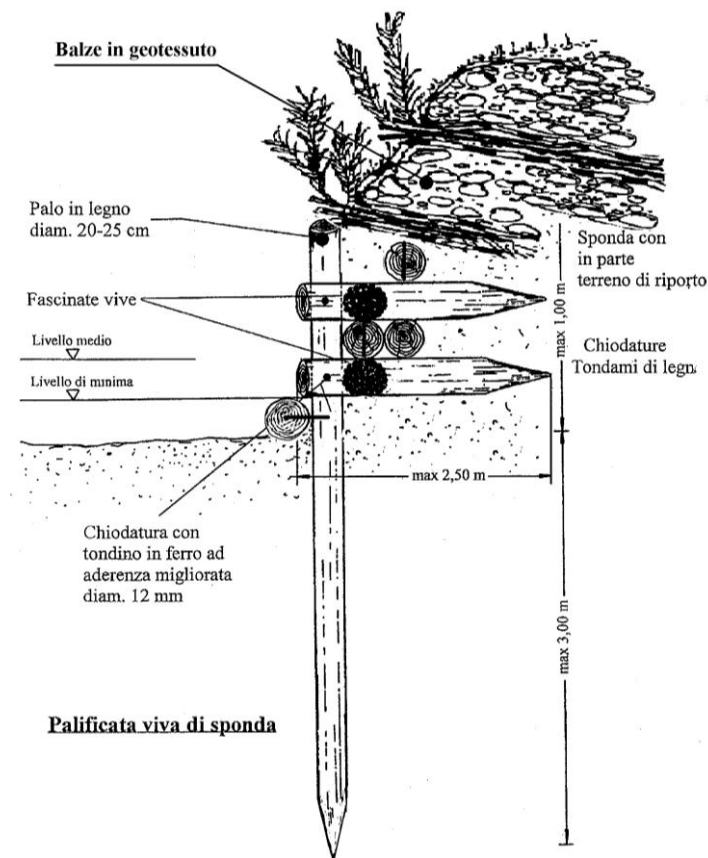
Sezione tipo di palificata viva di sostegno spondale.
